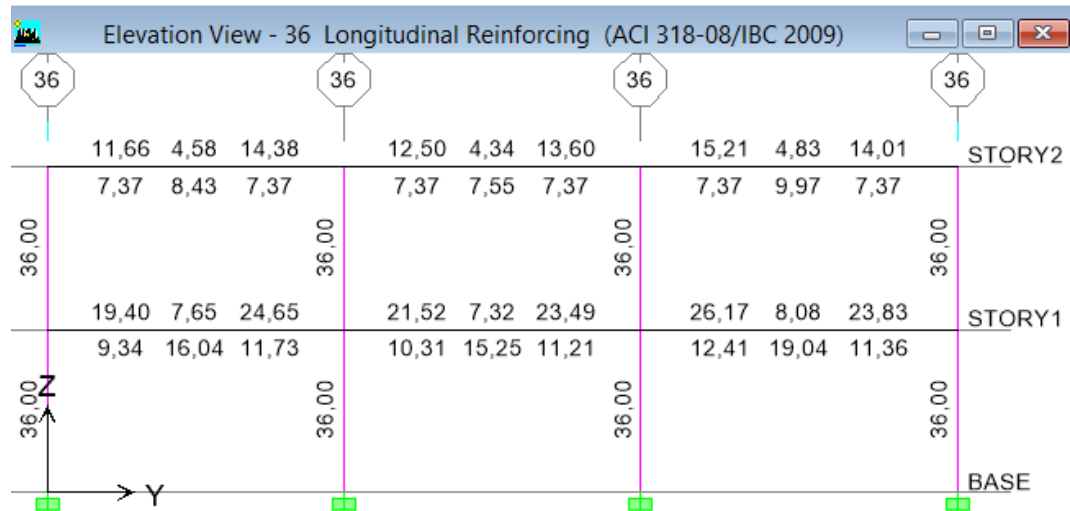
Acero en Vigas y Columnas en el Pórtico 36 – C. Quirúrgico- (CEC2002)
